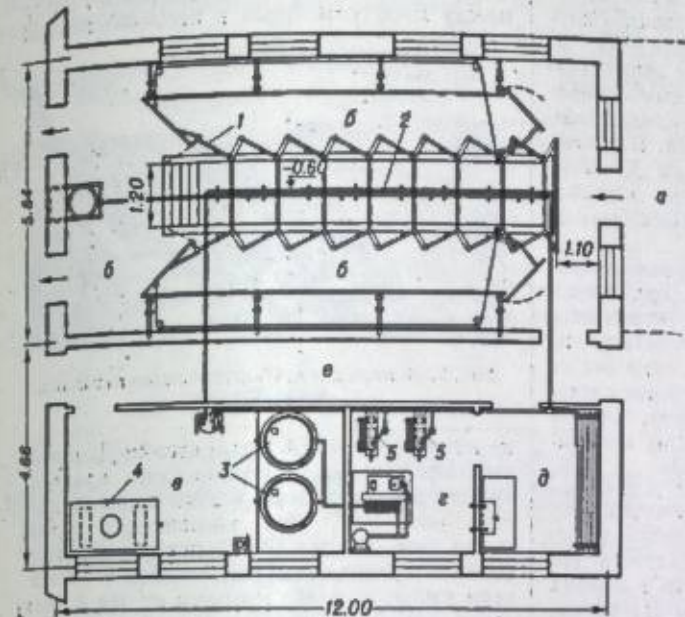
Доильная площадка типа «елочка» на 16 станков (план): а — преддольная площадка; б — доильное помещение; в — молокопровод; г — вакуум-насосная; д — моечная; е — котельная; ж — бытовые помещения; з — коридор; 1 — доильные станки; 2 — молокопровод; 3 — охлаждающая установка для молока; 4 — емкость для охлажденного молока; 5 — вакуум-насосы.
